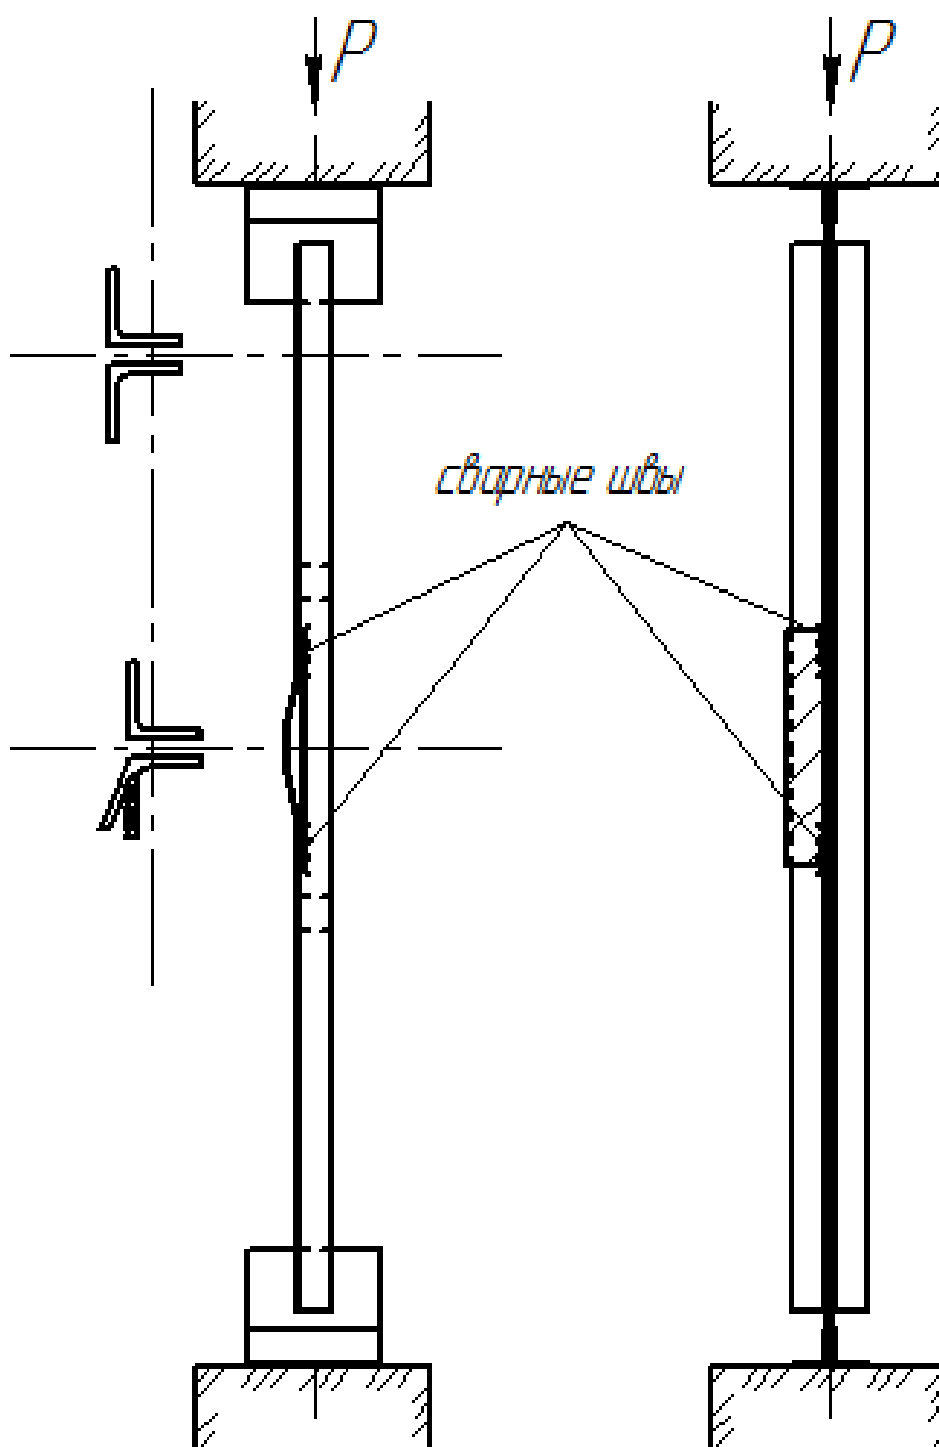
Схема установки для испытания образцов с усилением полосой
